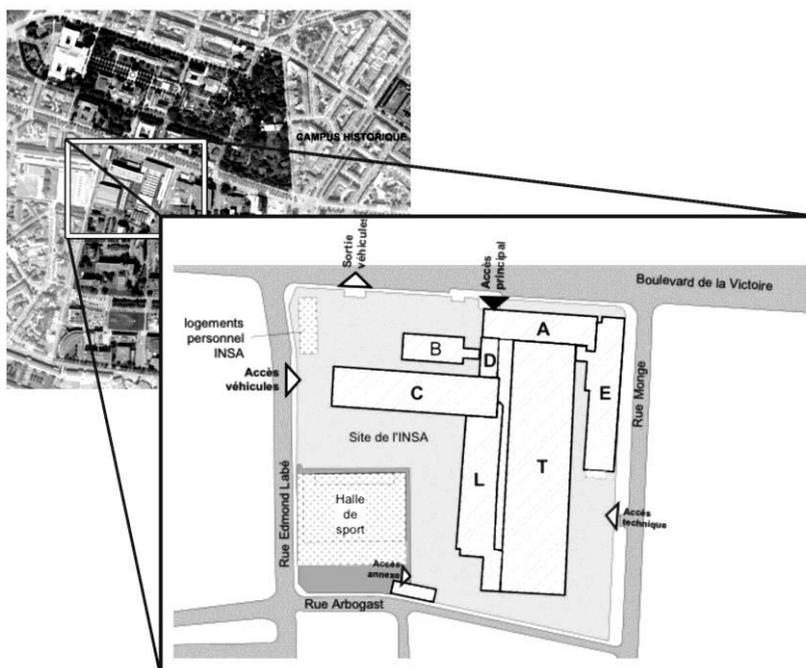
Le plan masse de l'INSA de Strasbourg.
